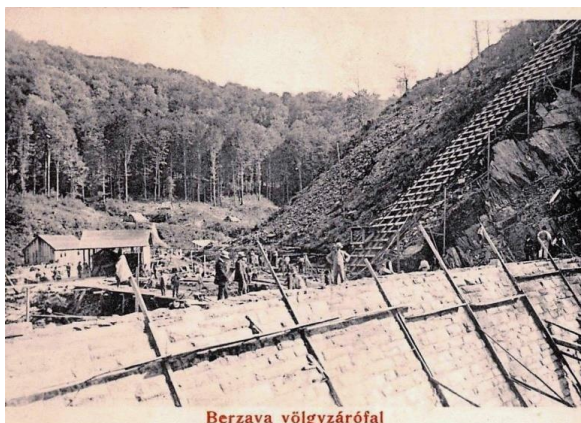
Planul înclinat de la Lalașint -comuna Bârzava
